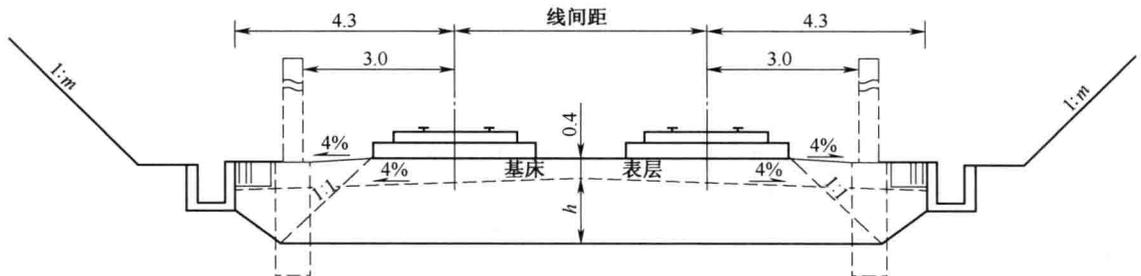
无砟轨道双线路堑标准横断面示意图(单位:m)
